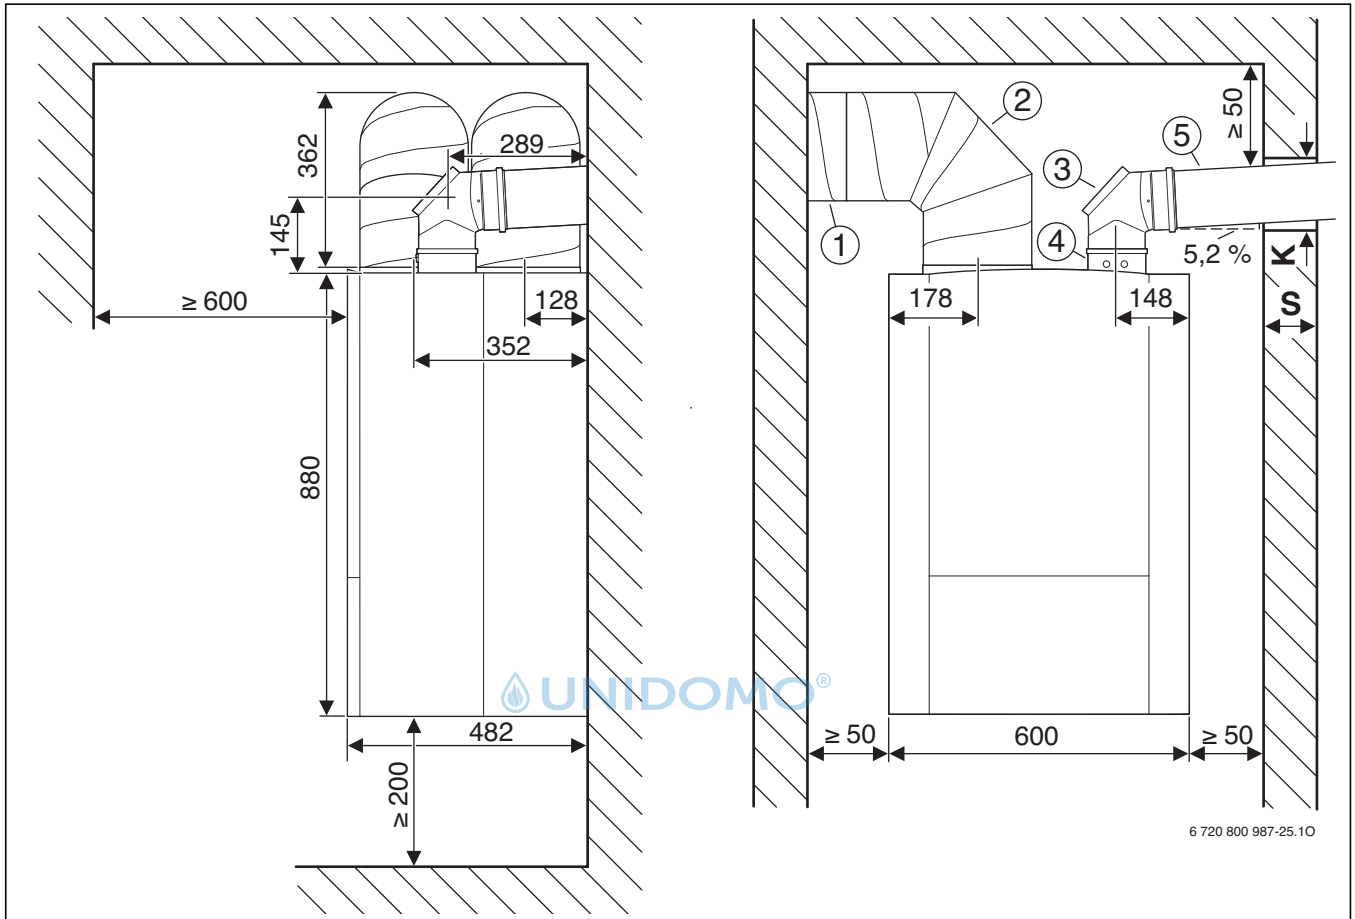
Abgasführung Ø 80/125 mm oder Ø 80 mm
